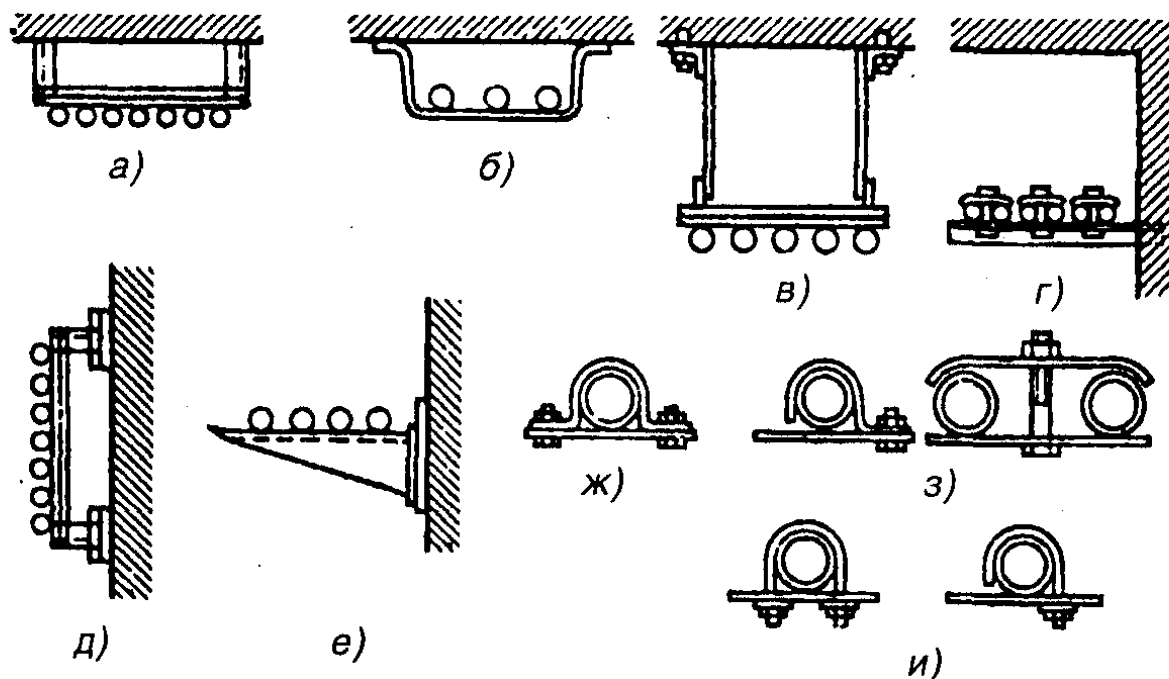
Способы крепления труб к опорным конструкциям:
